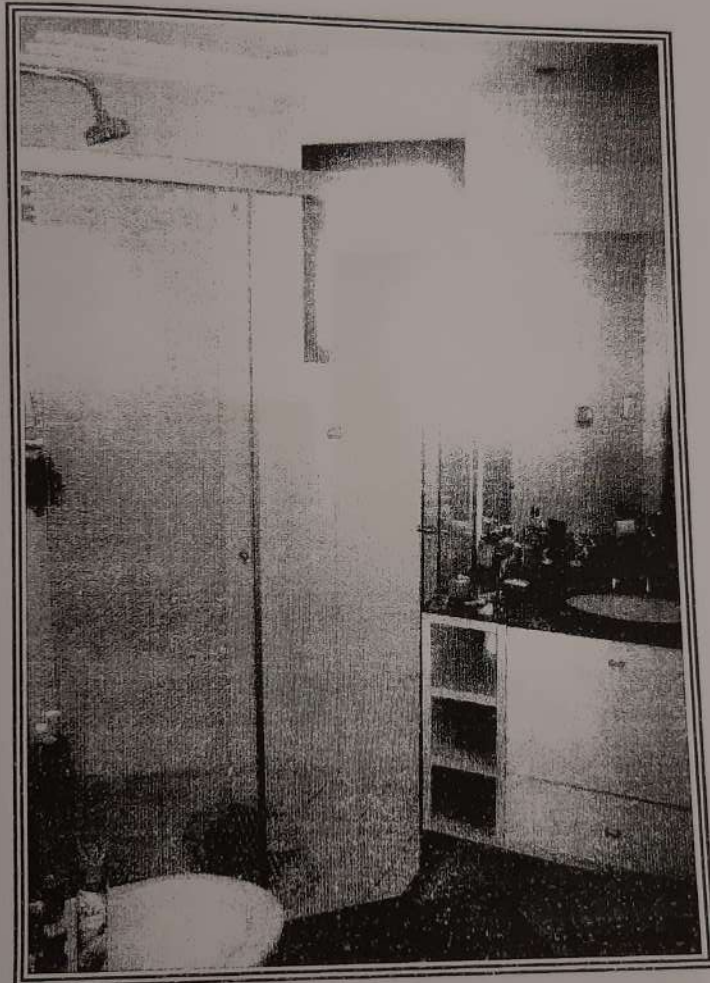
Vista do banheiro do dormitório 02 (suíte)
